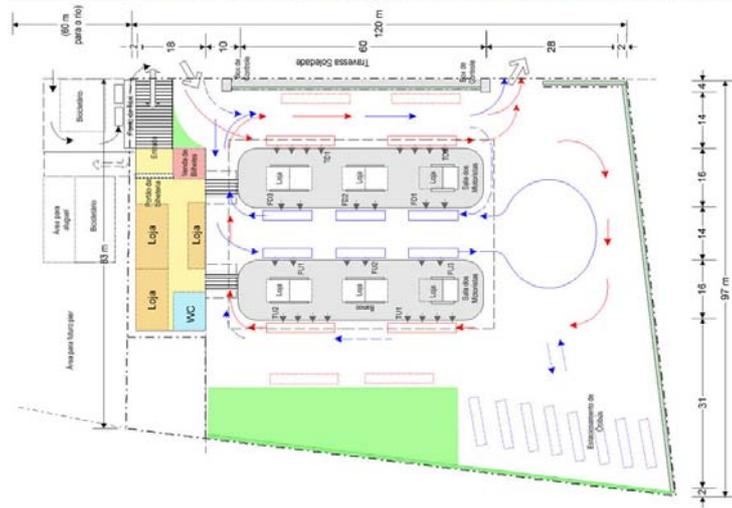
Planta do Terminal A: Icoaraci (sem escala)
